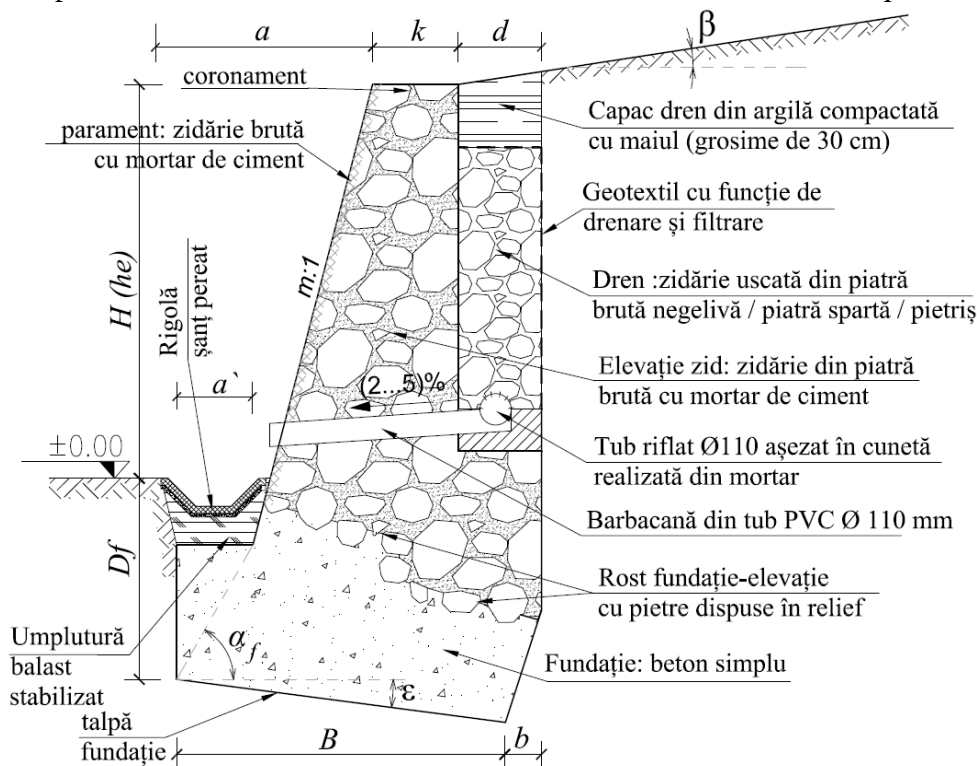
Secțiune transversală zid de sprijin din zidărie de piatră
